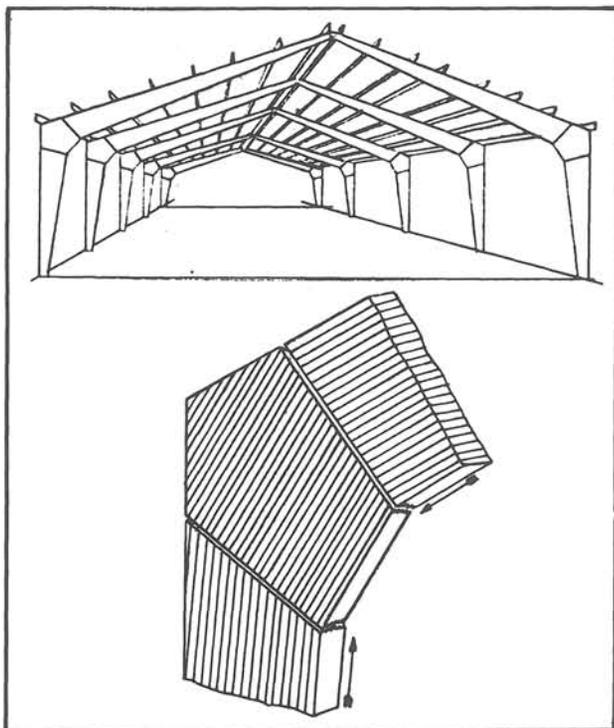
Detalle de ensamblaje en ángulo por cuña de madera laminada.
